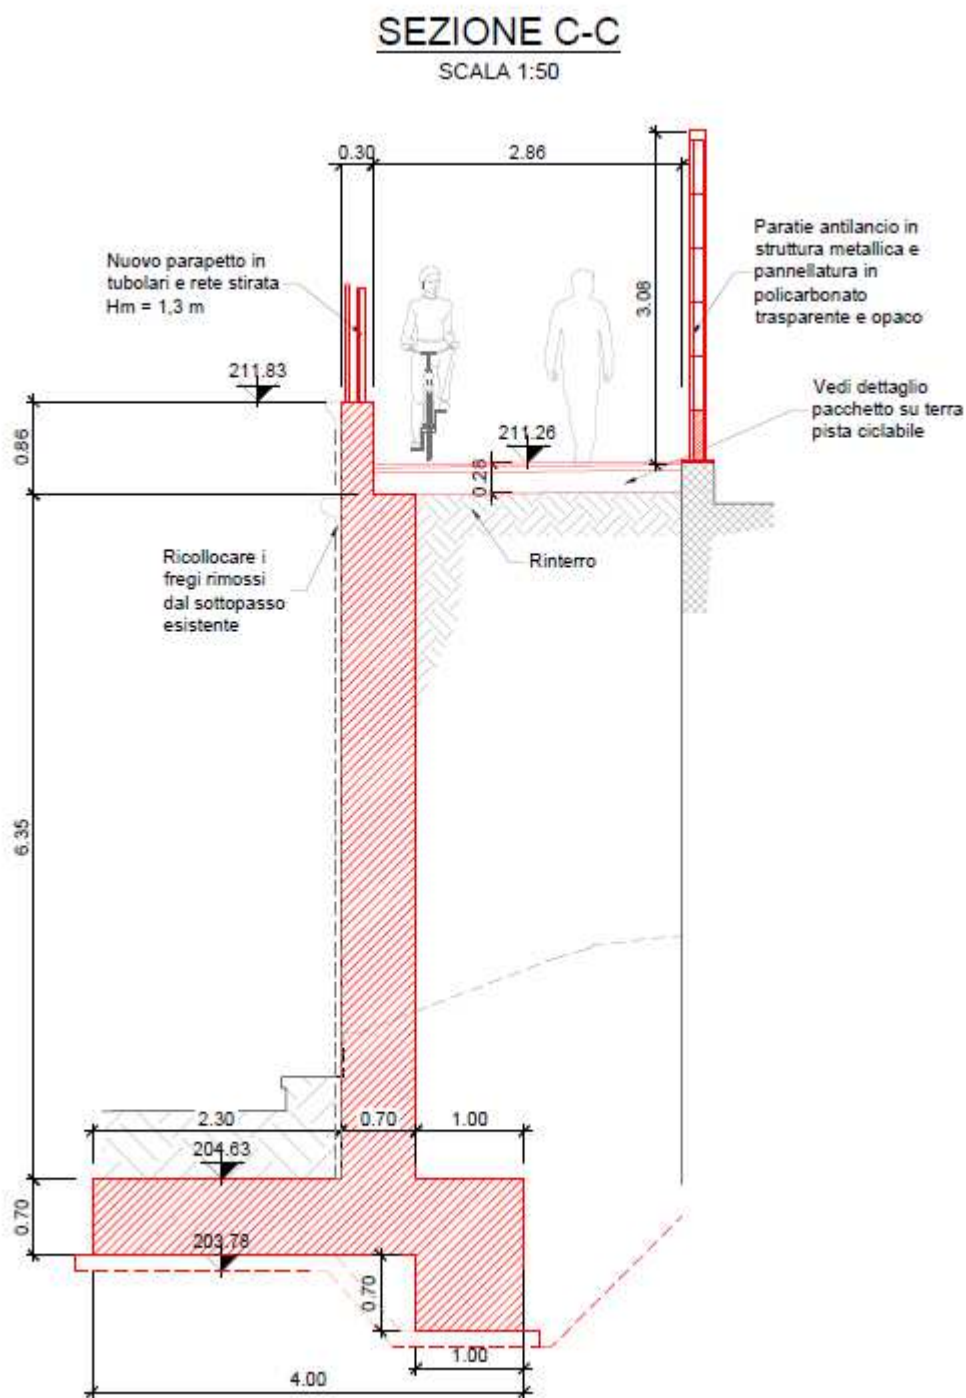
Sezione trasversale tipica Muro controterra intervento B1
